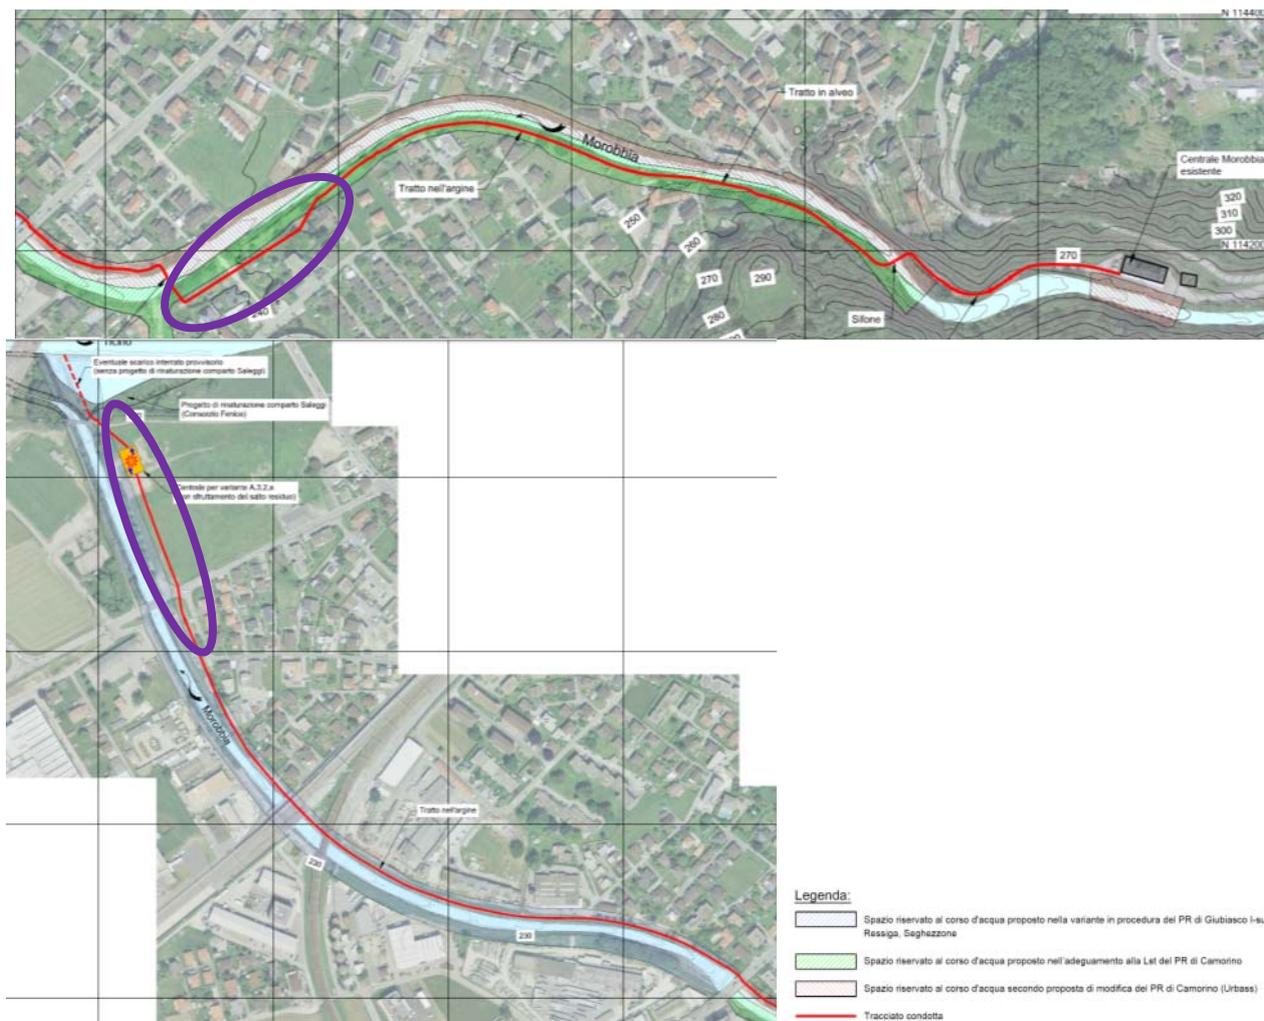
Estratto dai piani di progetto – adeguamento della nuova condotta rispetto allo spazio riservato alle acque (in viola sono evidenziati i tratti per i quali la condotta è stata spostata fuori dallo spazio riservato alle acque)
